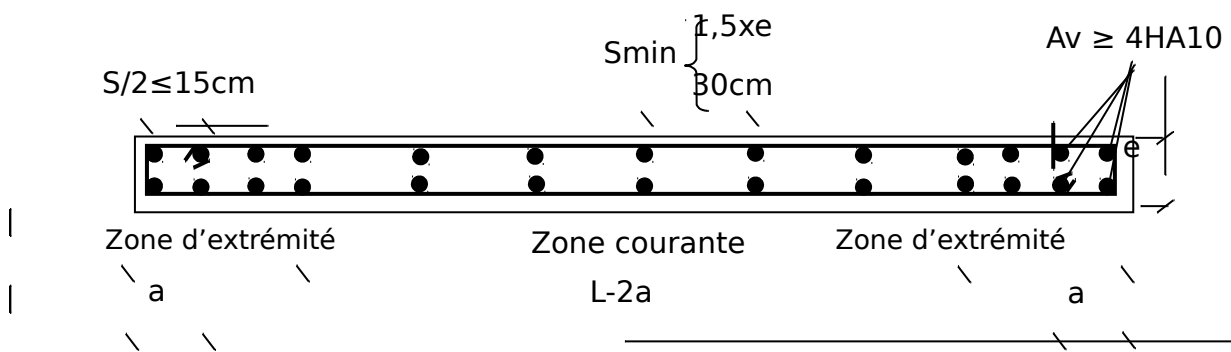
Disposition des armatures verticales dans les voiles.
